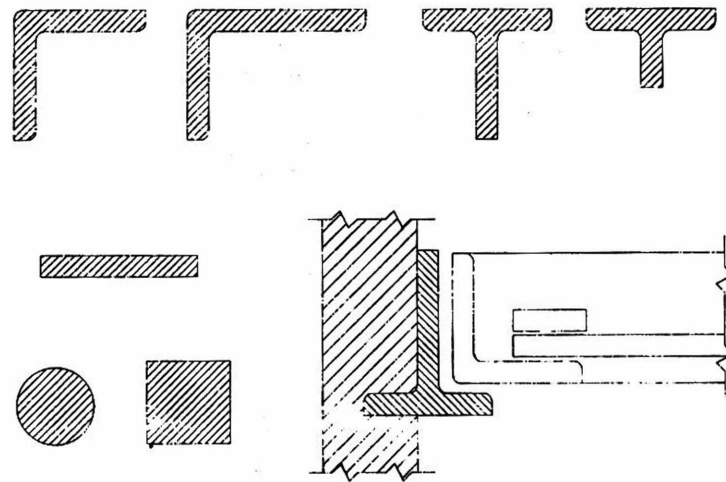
Perfiles de acero para carpintería metálica (herriería).
